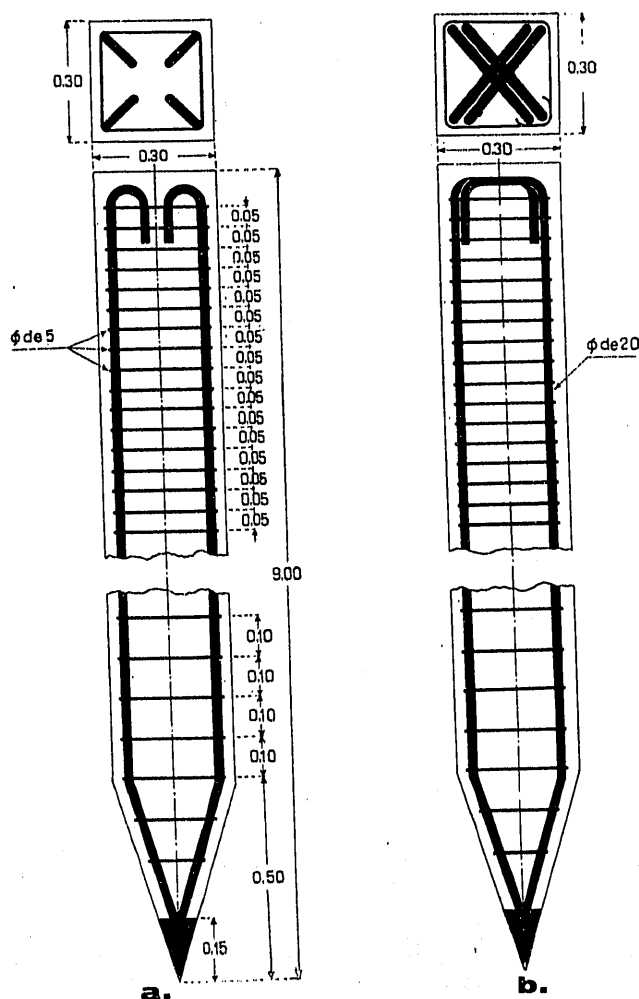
Pilotes de hormigón armado: a, armadura proyectada; b, ídem construida
